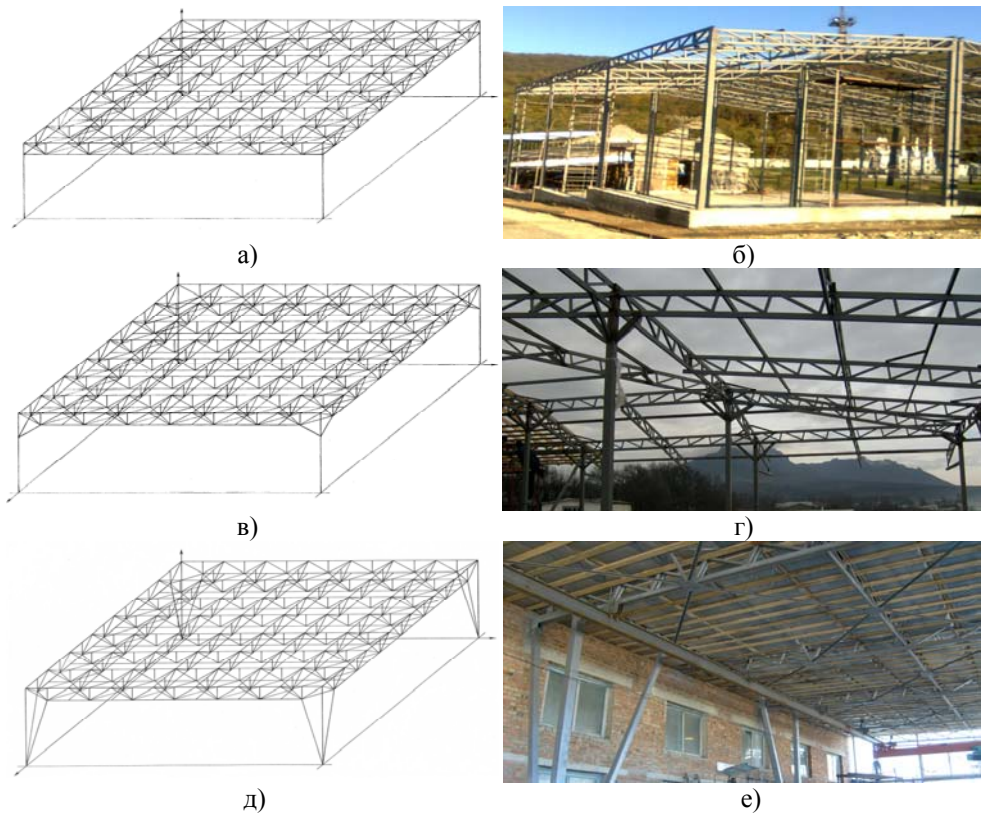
Расчетная схема и снимок пространственного покрытия из перекрестной системы с приопорными панелями нижних поясов контурных ферм (а, б); расчетная схема и снимок пространственного покрытия из перекрестной системы с подкосами контурных ферм (в, г); расчетная схема и снимок пространственного покрытия из перекрестной системы с наклонными ветвями V-образных колонн (д, е)
